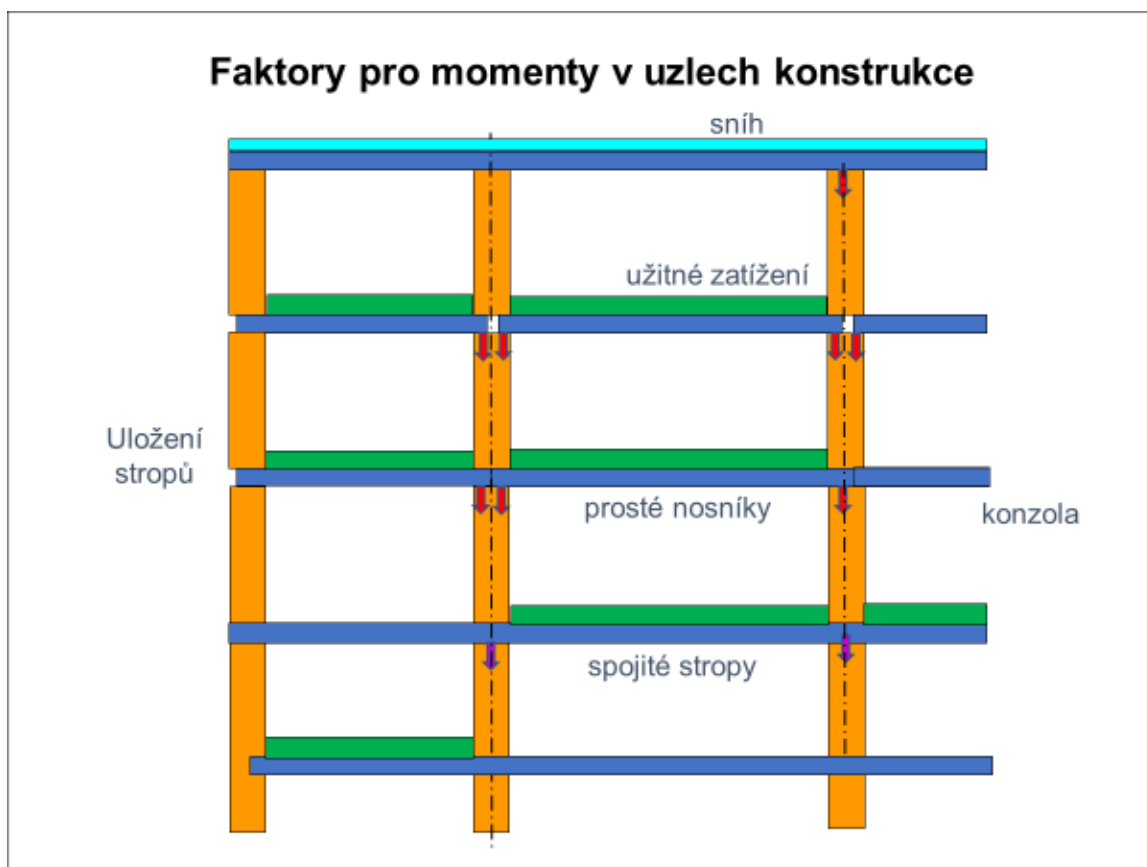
Schématický model pro pružnou soustavu s excentricitou uložení stropu
